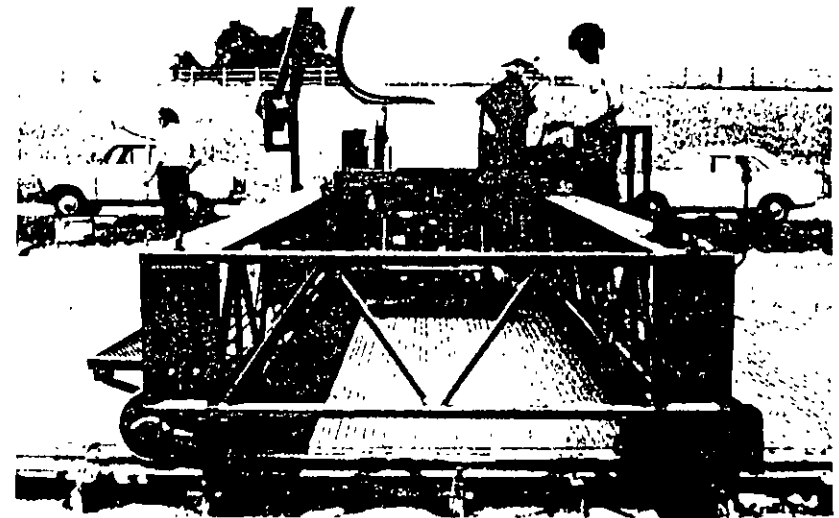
Máquina formadora de surcos en una superficie de hormigón recién pavimentada.
